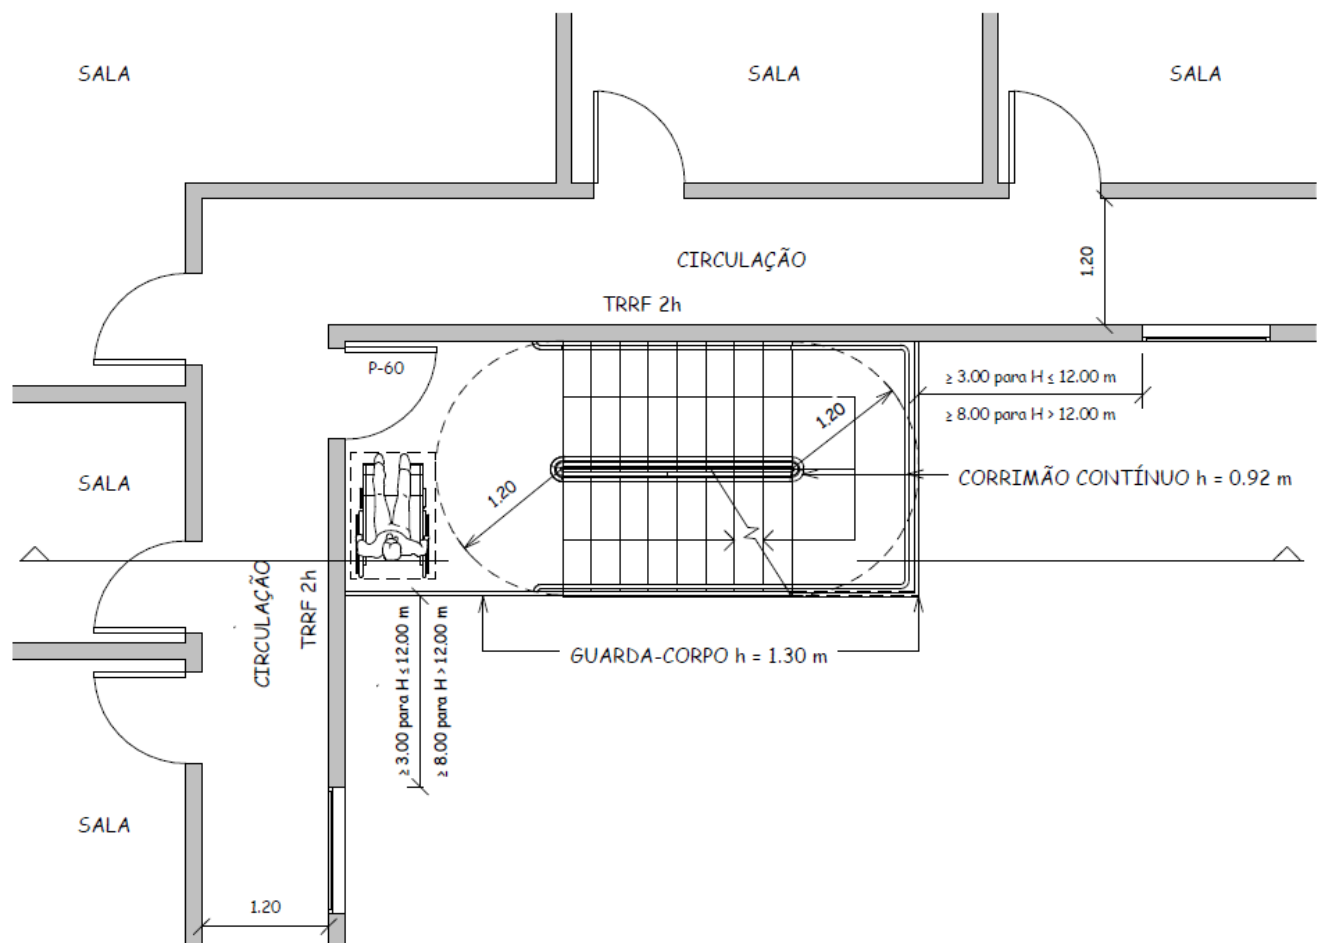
B - Escada aberta externa - pavimento intermediário (planta baixa).
